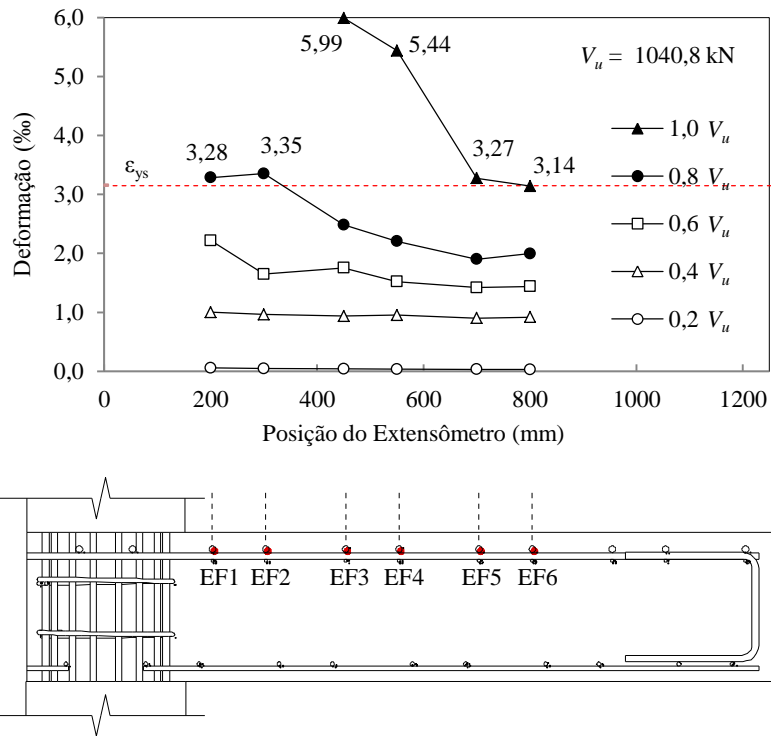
Deformações nas armaduras de flexão da laje SS1
